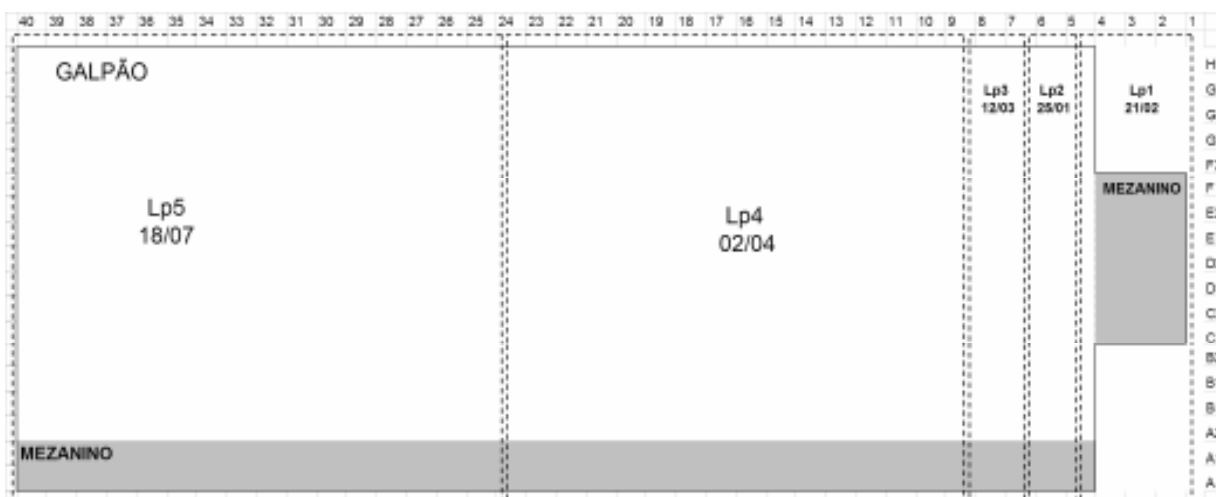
Divisão final da obra em lotes de projeto de DI
